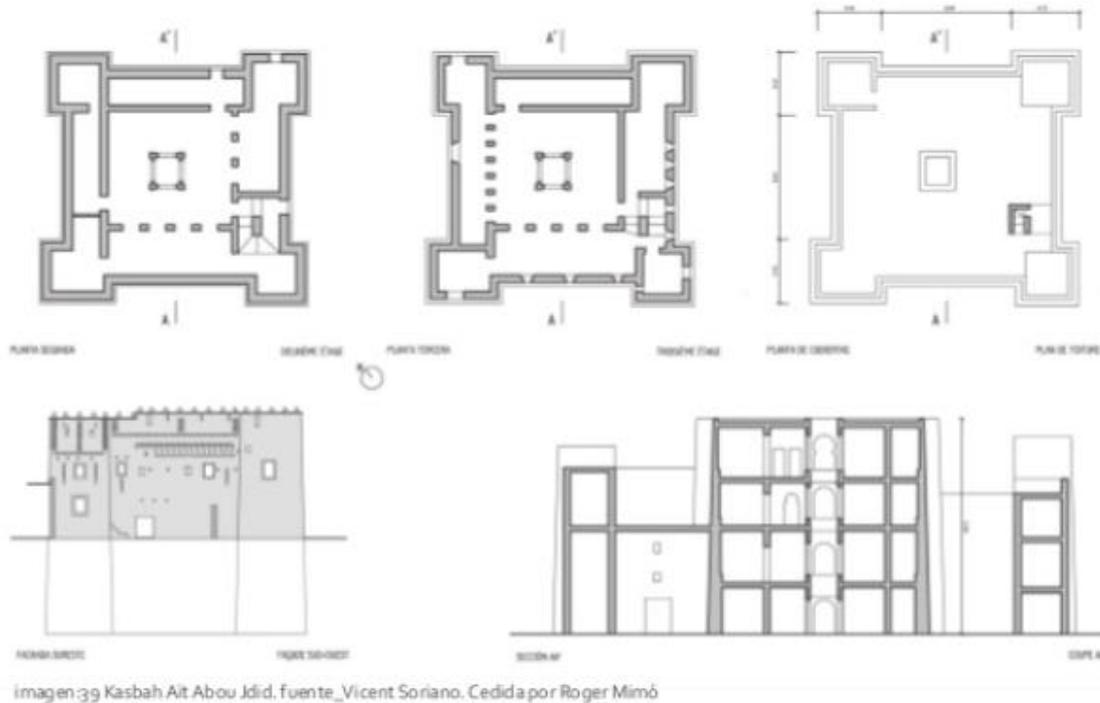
Plantas, alzado y sección de la Kasbah 'Ait Abou Jdid'
